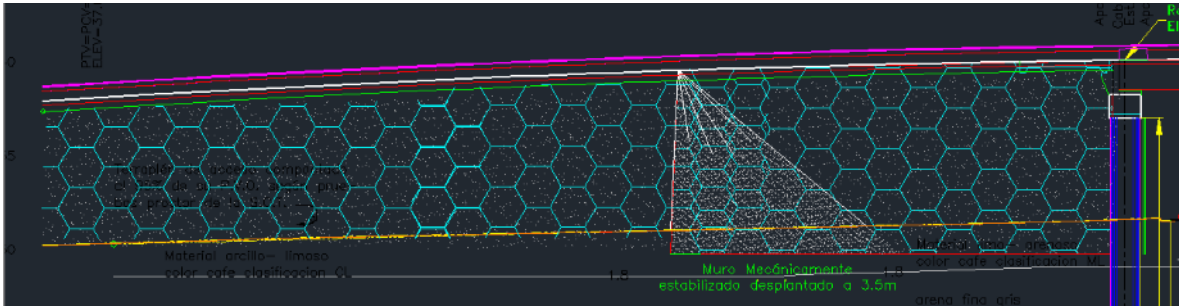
Diseño del muro mecánicamente estabilizado considerado por el proyecto.
